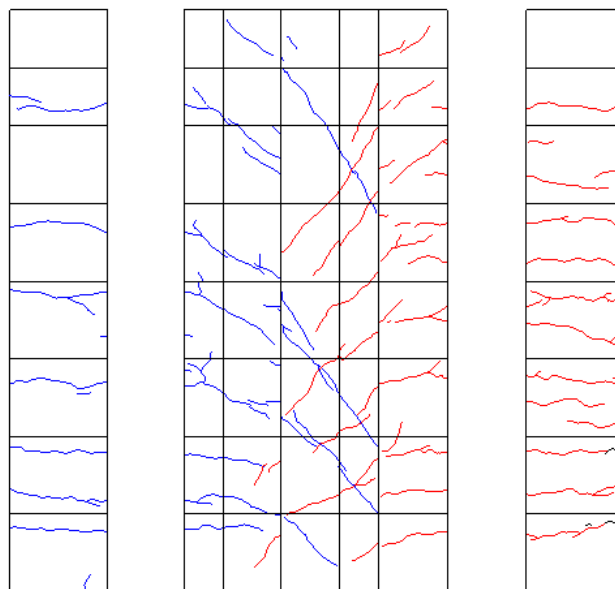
R=1/133 ひび割れ図
